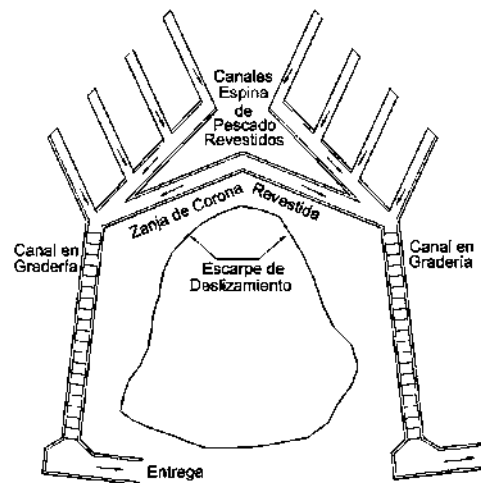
Esquema en planta de canales colectores espina de pescado.
